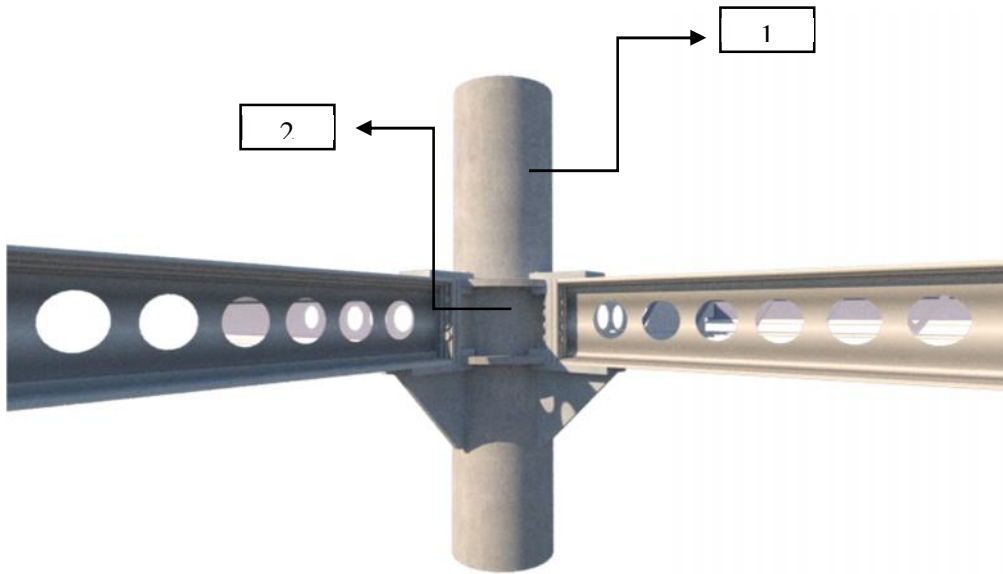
Esquema de unión entre columna y viga Boyd Alveolar.
